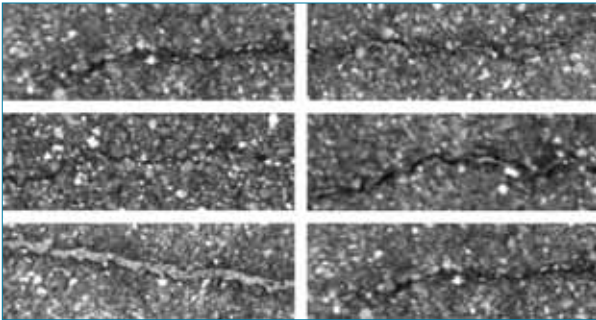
Imágenes de grietas y fisuras transversales de la base de datos.
